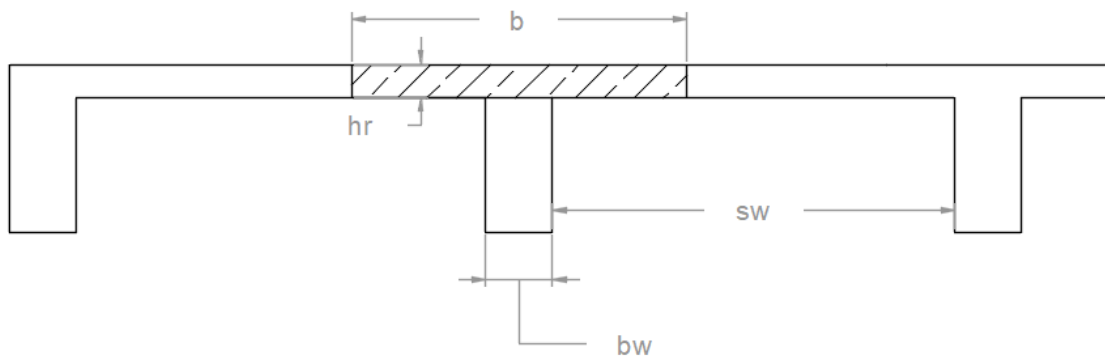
Ancho efectivo de contribución de la losa, viga interior
